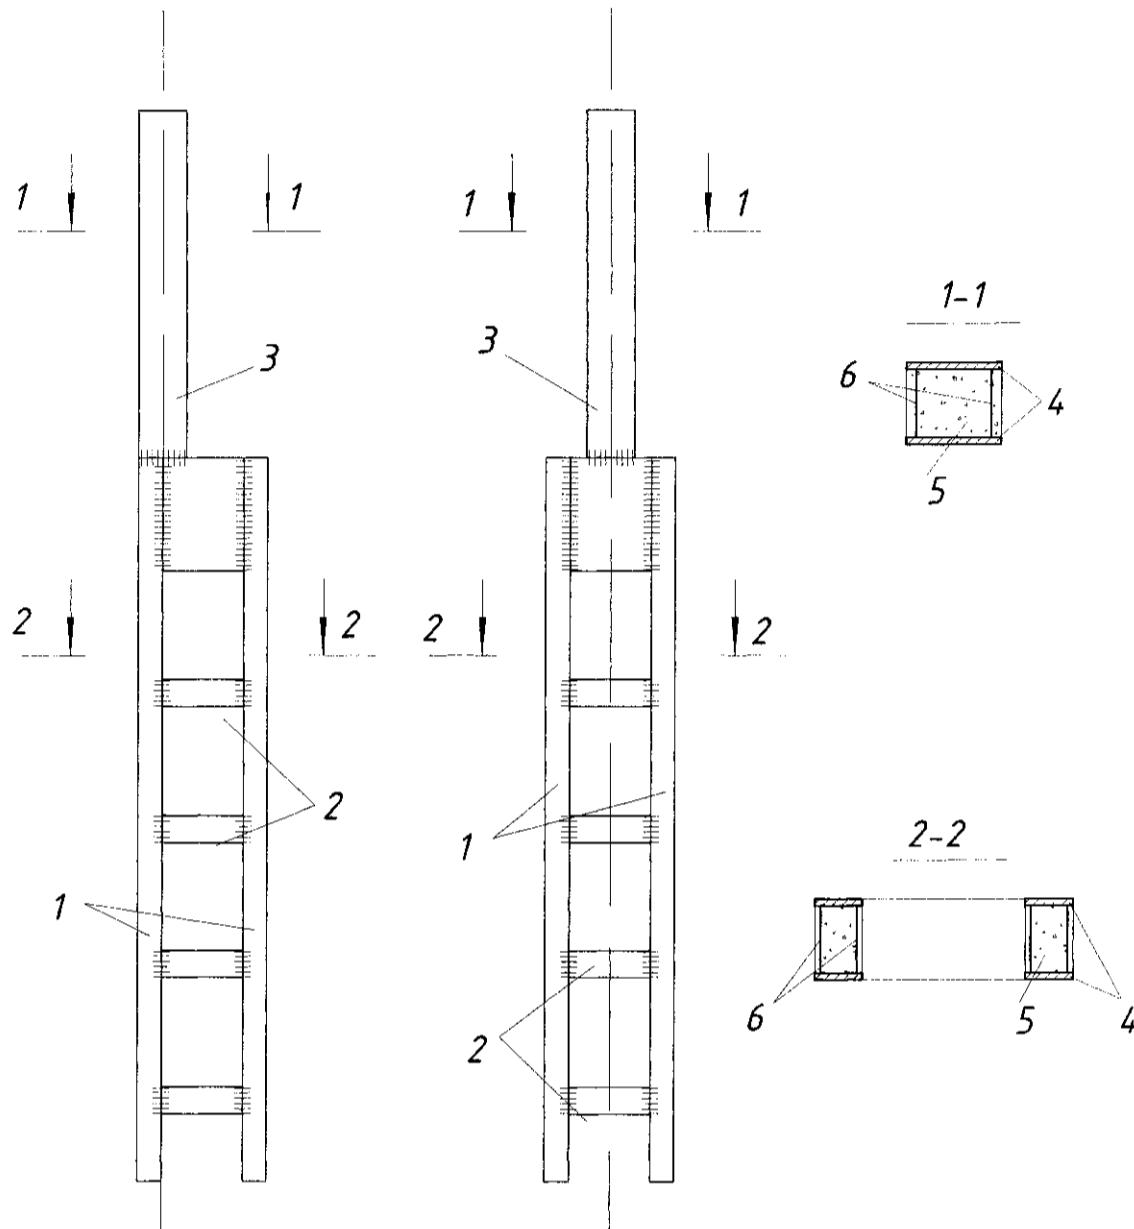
Наскрізна залізобетонна колона із зовнішнім листовим армуванням:
